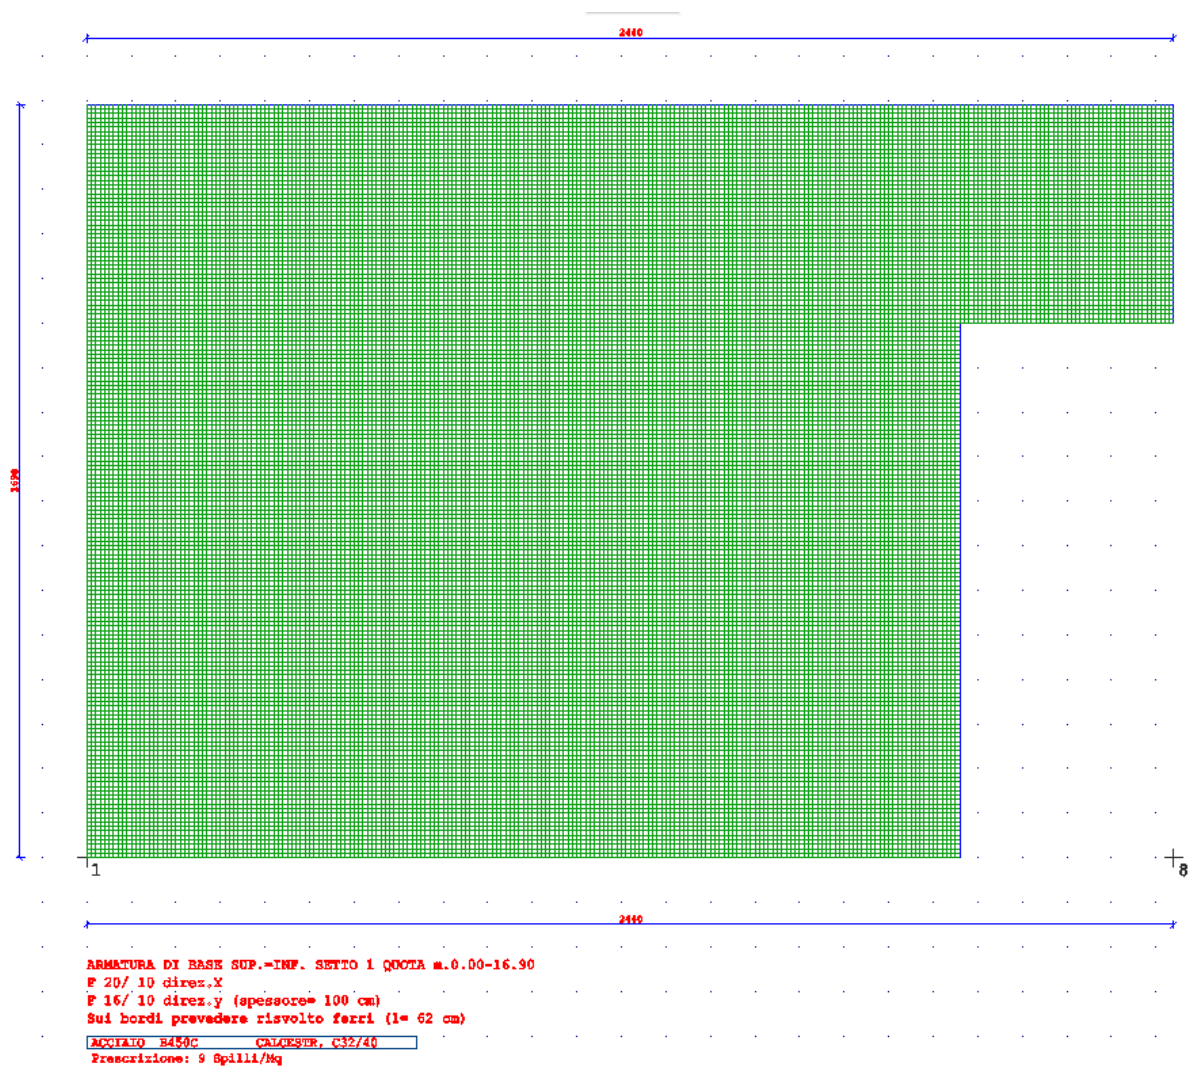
Armatura setto 1 alle quote strutturali indicate
